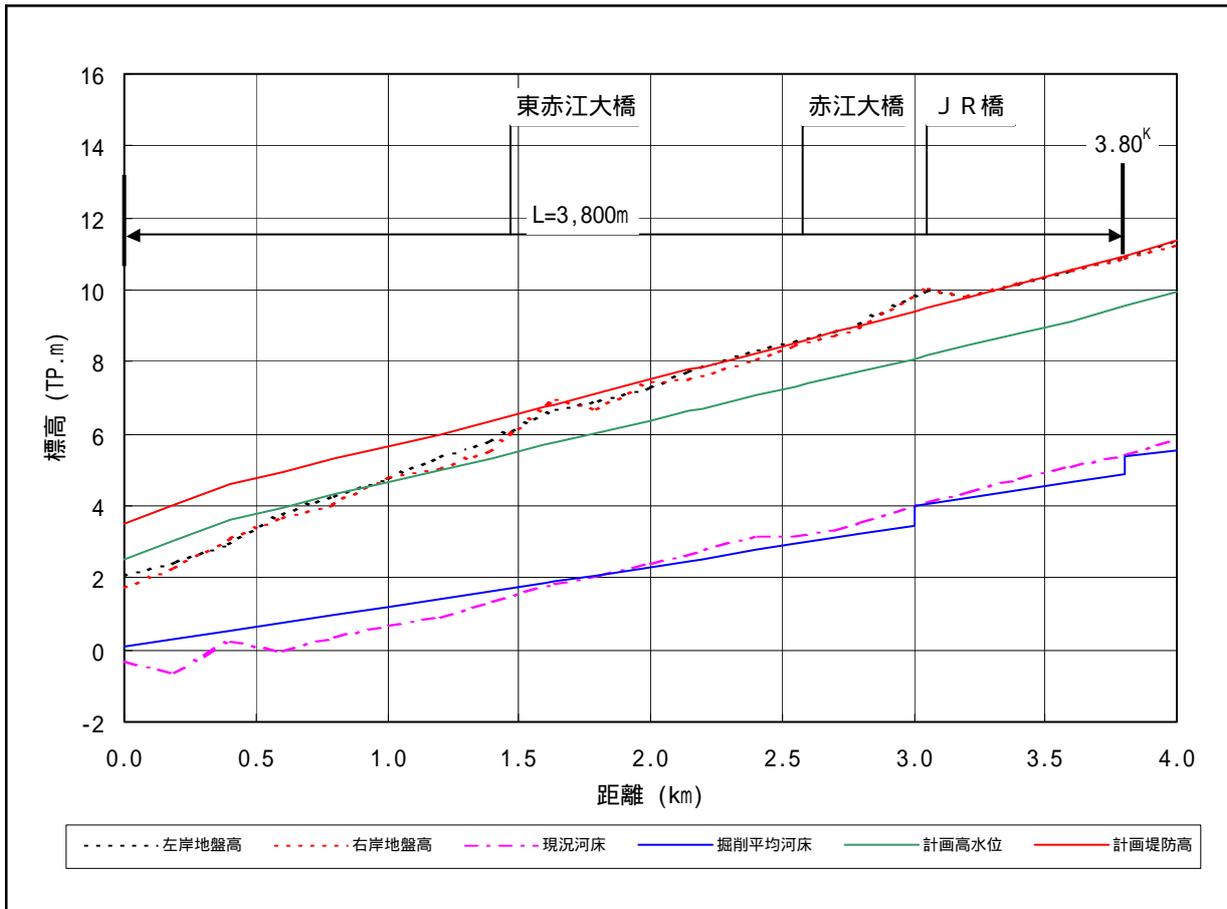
(3) 飯梨川下流工区縦断面図
